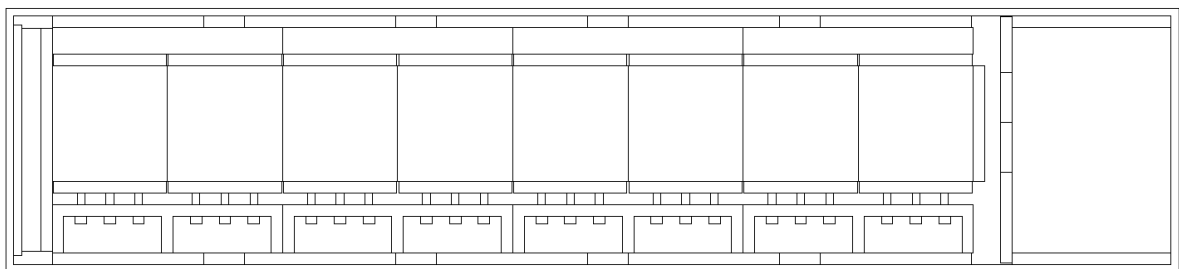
Zusammenstellung der Stützung der 30-iger-Blöcke im Grundriss
